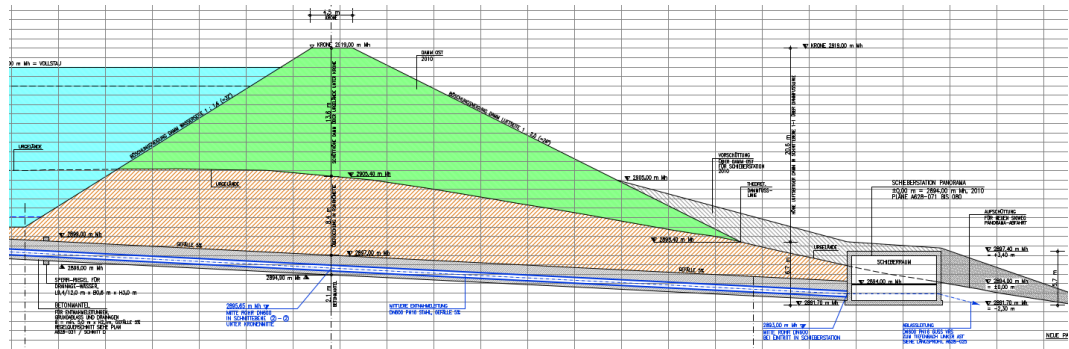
Schnitt durch den Damm Querprofil gemäß Plan A628 – 022/1
